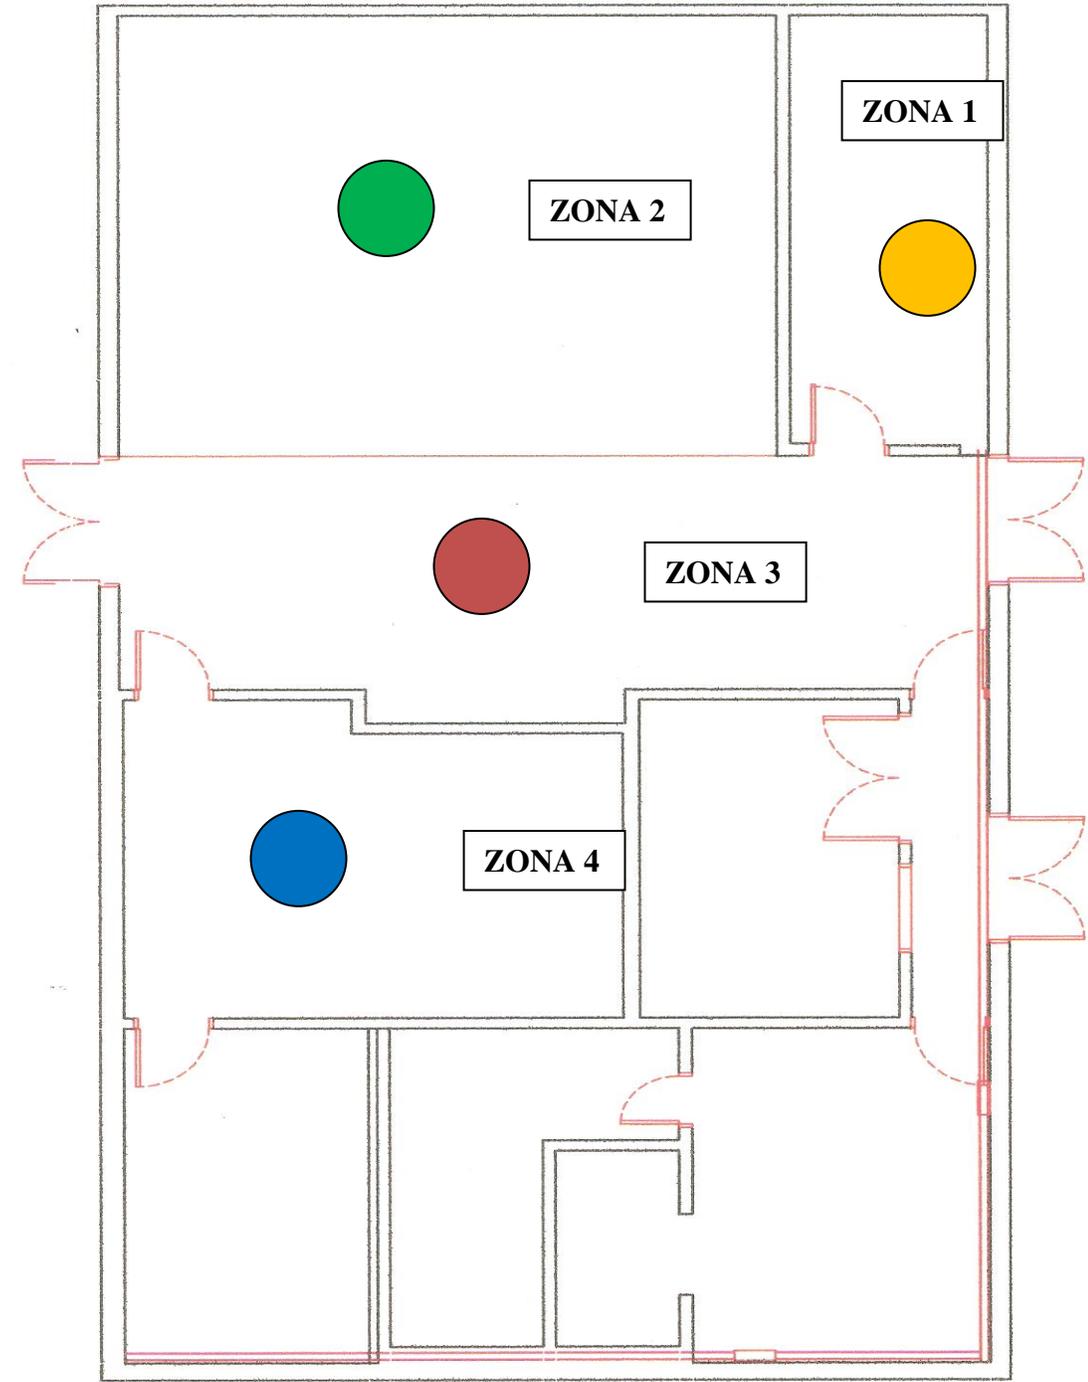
Plano de la Distribución de Zonas Edificio Nro.1
